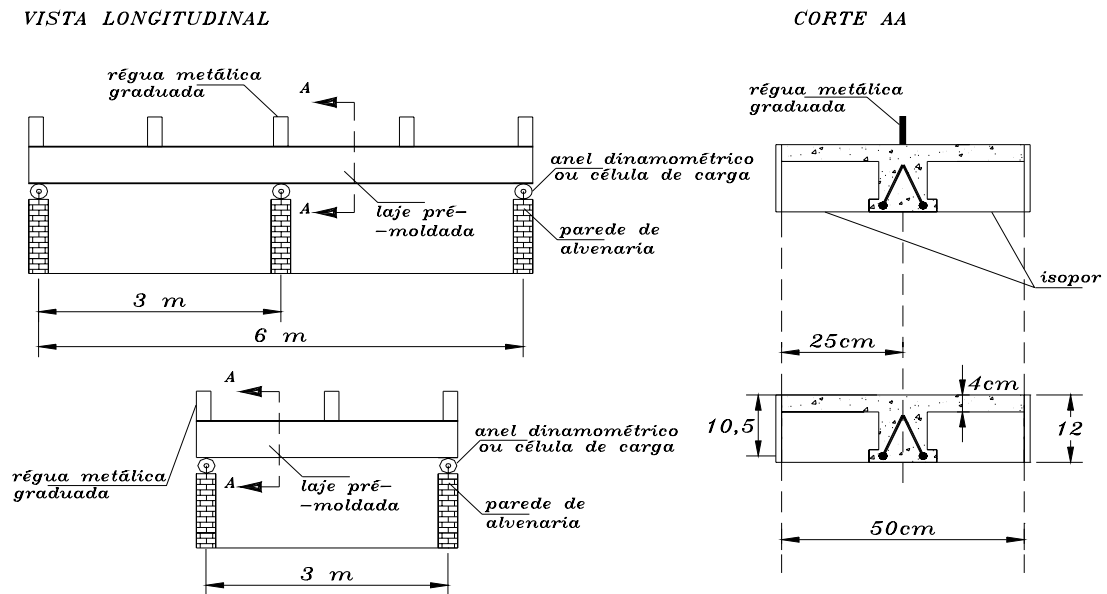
Protótipos com uma vigota – Vista longitudinal e corte transversal.
